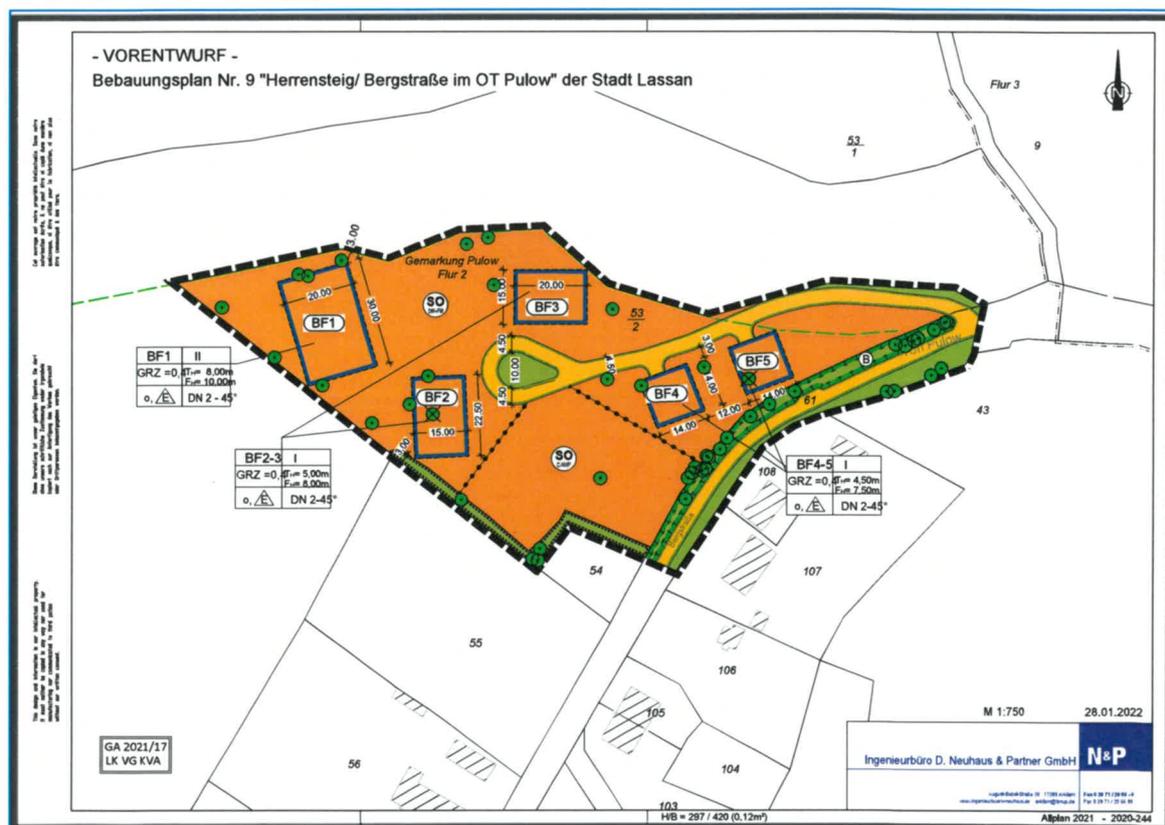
Planzeichnung – Bebauungsplan Nr. 9 der Stadt Lassan
